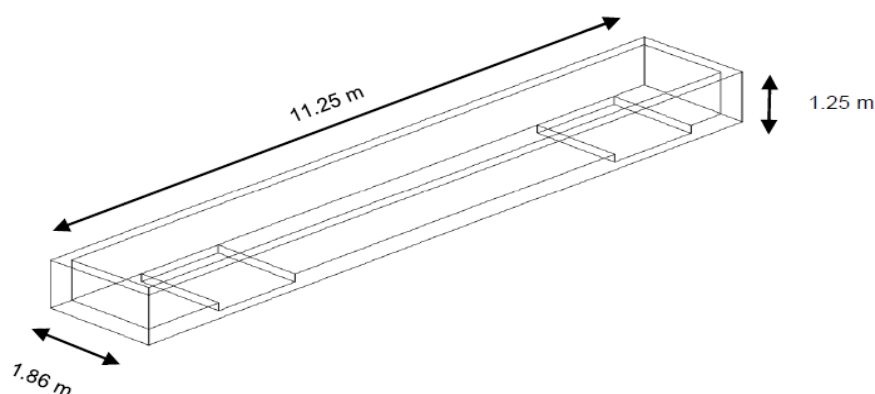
Prefabricado Tipo U (Proyecto Matarani, 2013)
